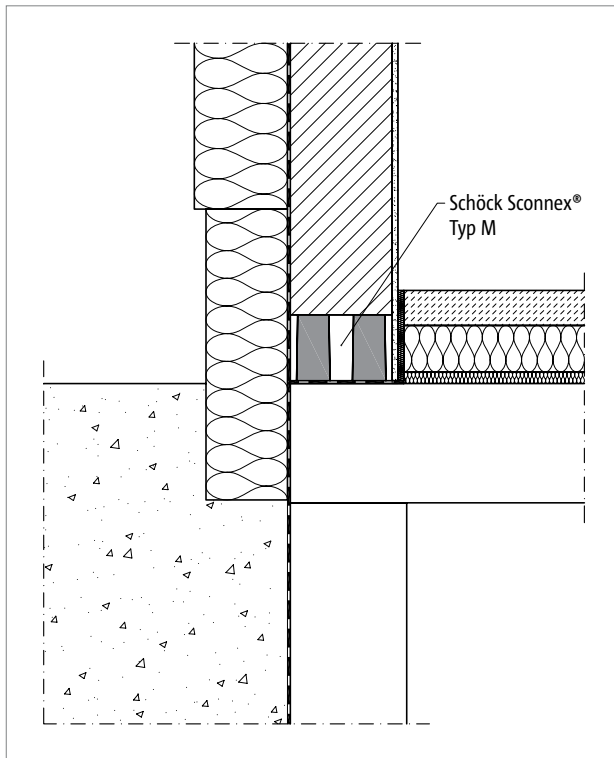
Schöck Sconnex® Typ M: Einbauzustand bei Wärmedämmverbundsystem
